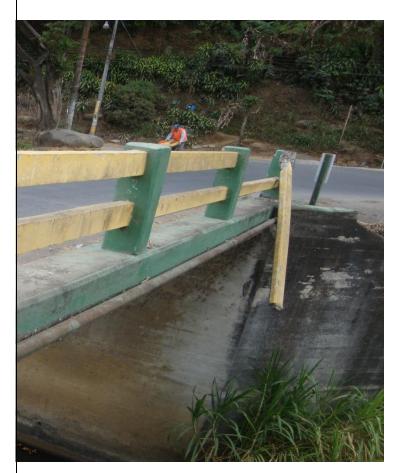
Faltante de baranda de concreto. Fuente: PEEP (2018).
